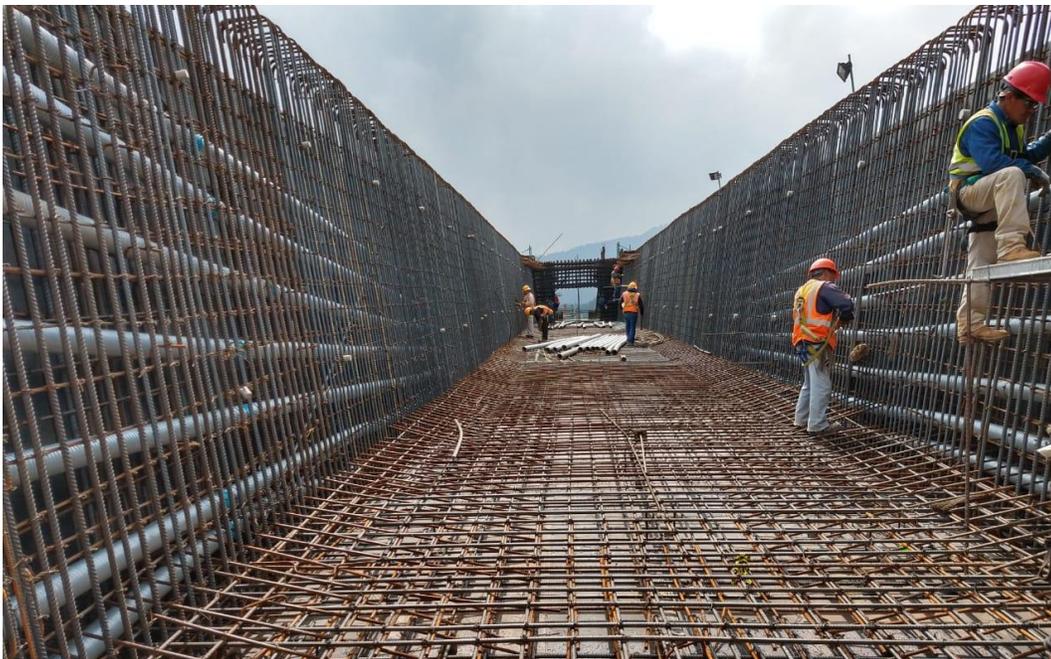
Armado de refuerzo de Autocimbra Mecanotubo
